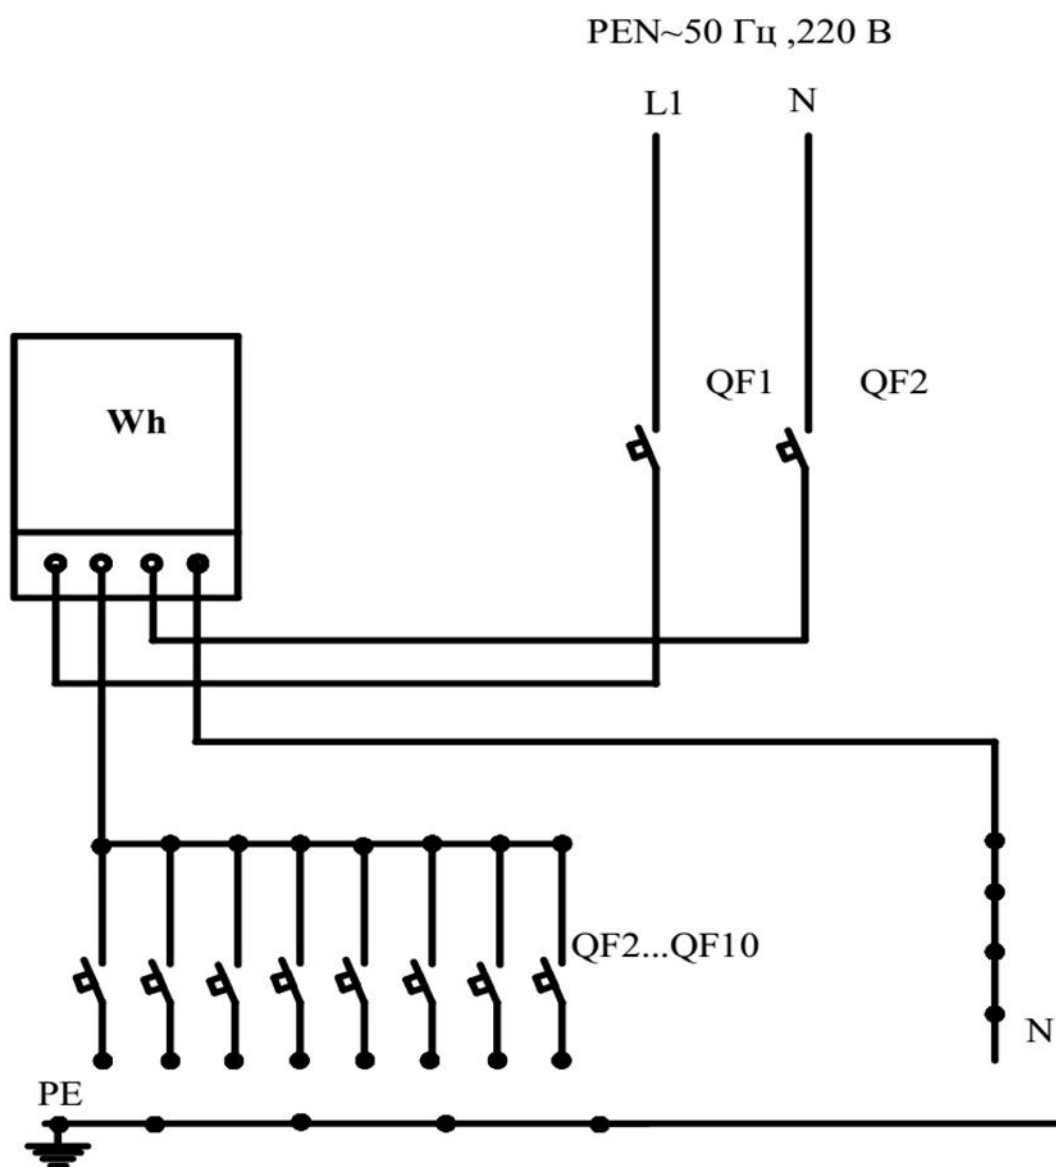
Схема електрична принципова щитка ЩК8805-0208
